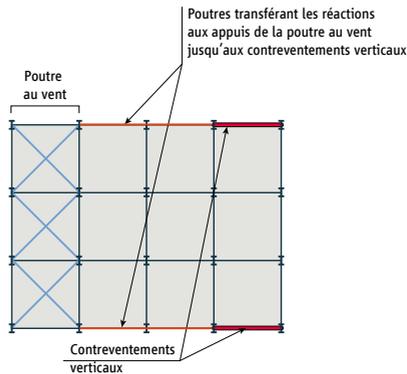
Décalage possible de la poutre au vent et des contreventements verticaux
